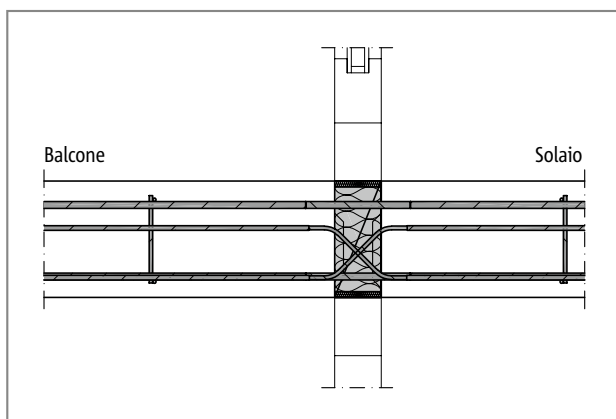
Schöck Isokorb® T tipo DL: sezione costruttiva; solaio monodirezionale
